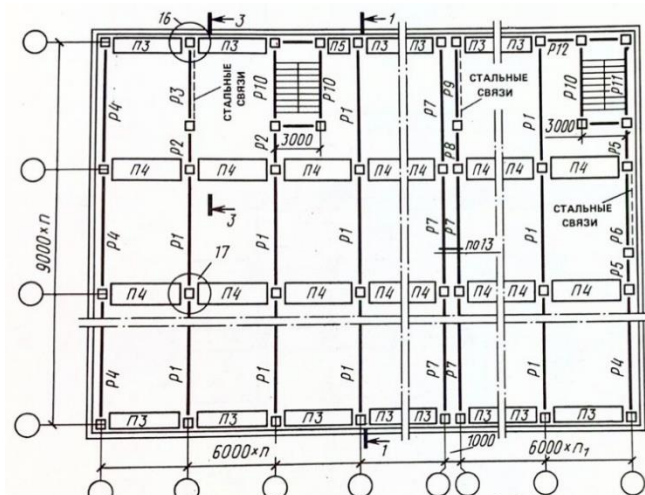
Схема расположения ригелей и связевых плит в перекрытиях зданий с сеткой колонн 9x6 м с поперечным расположением ригелей.
